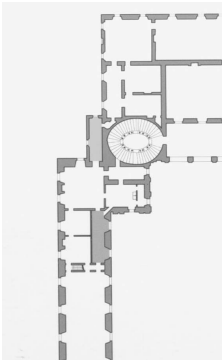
Grundriss des appartamento segreto vor Urban VIII.
